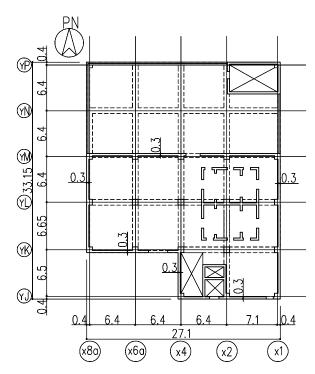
塔屋階平面図 (G.L.+11.0) (単位:m)
